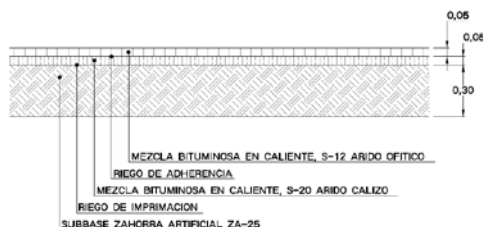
Plano de pavimentación de la zona oeste de Nafarroa kalea. 2/2
